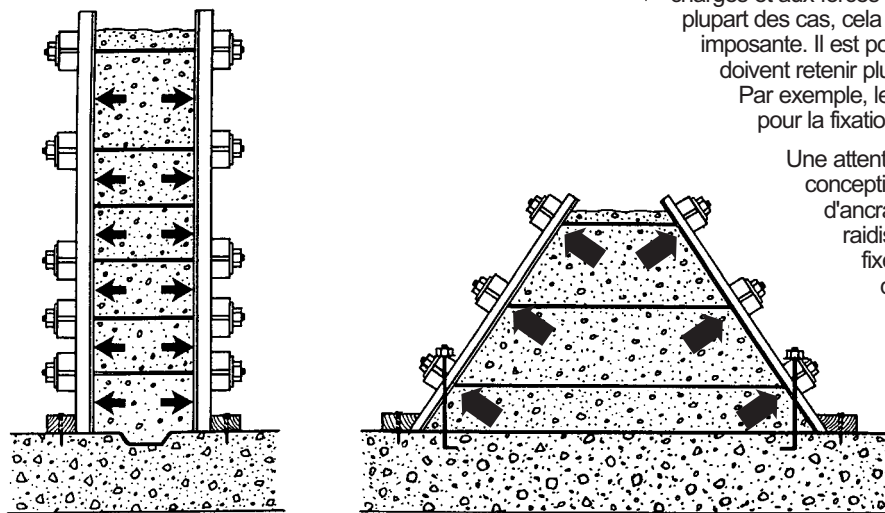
Pression du béton sur coffrage vertical et coffrage taluté
